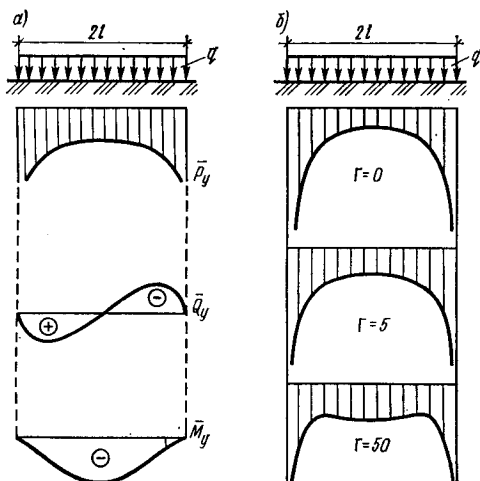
Характер распределения усилий (а) на фундаментную балку и эпюры реактивных давлений (б) по ее подошве
